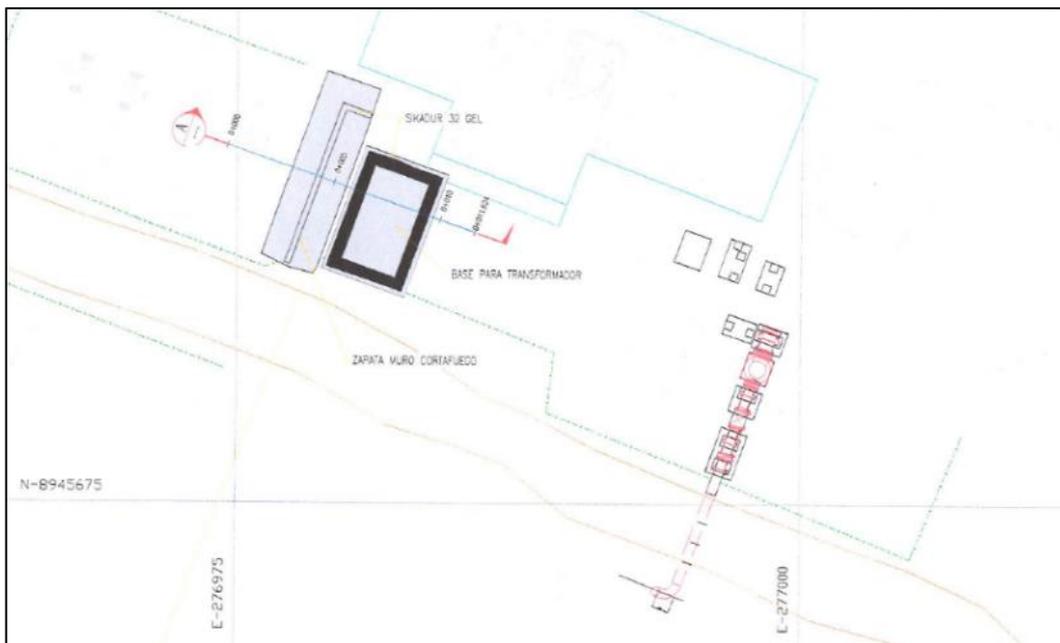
Plano de relleno de concreto de zapata y base de transformador
